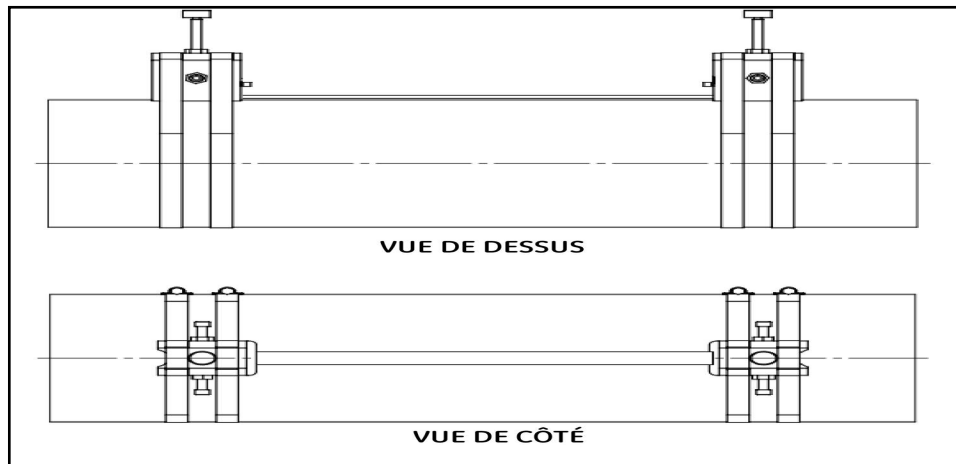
Installation du système de montage SCF terminée, sans transducteurs
